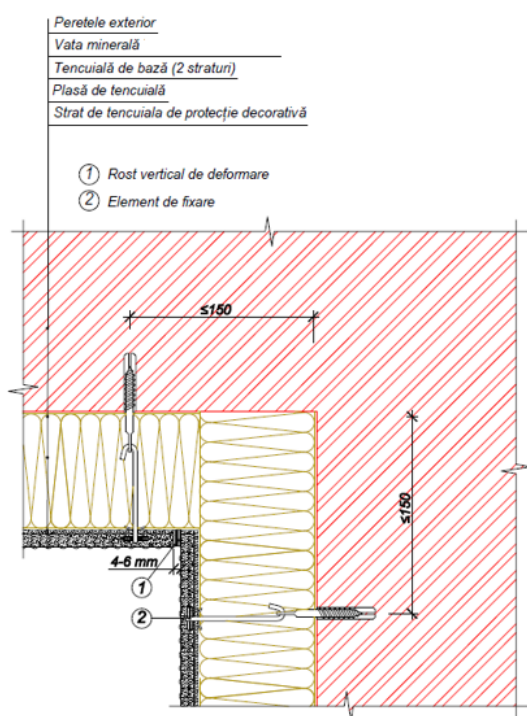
Izolarea termică a colțului intern și amenajarea rostului vertical de deformare. Profil orizontal
